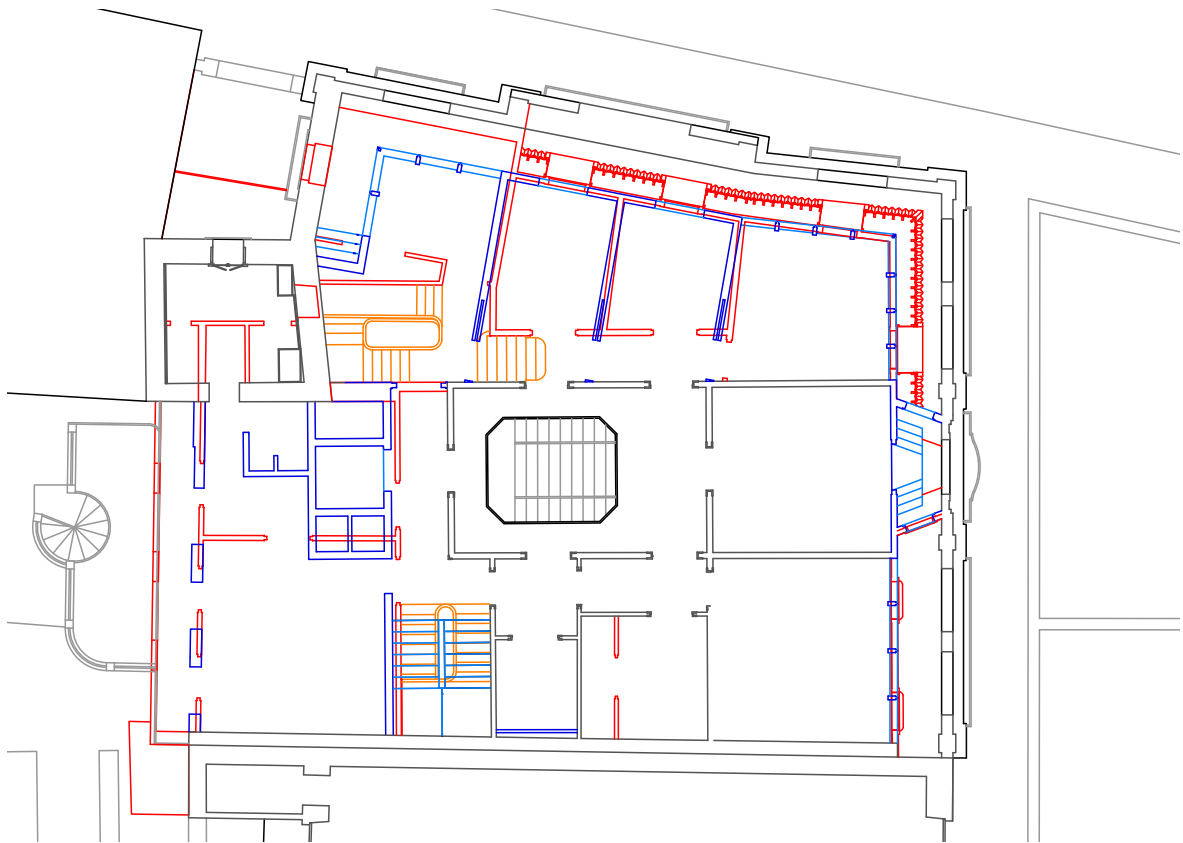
Planta de demolições e novas construções - segundo piso - escala 1:200
